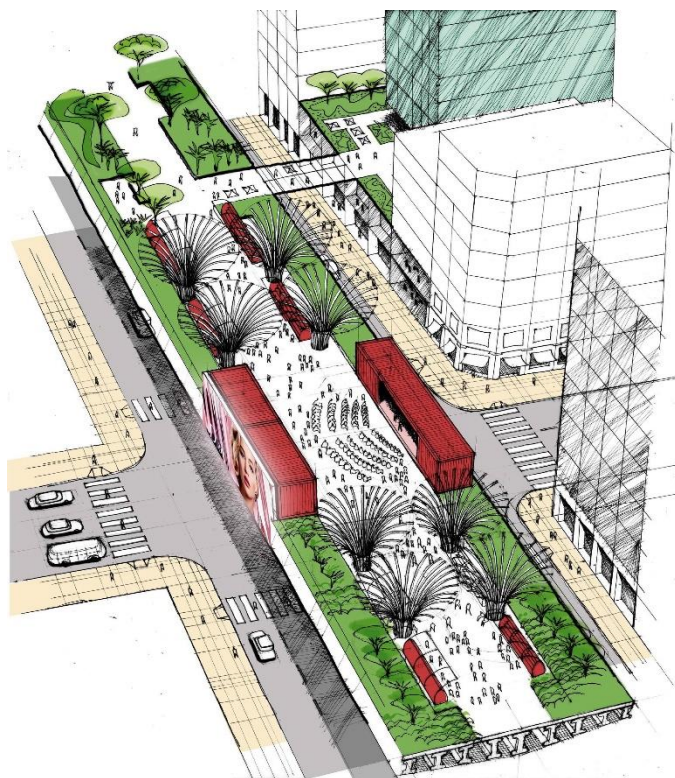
Vista contemplando palcos em vermelho - Fonte: Projeções Lemer Arquitetos Associados
